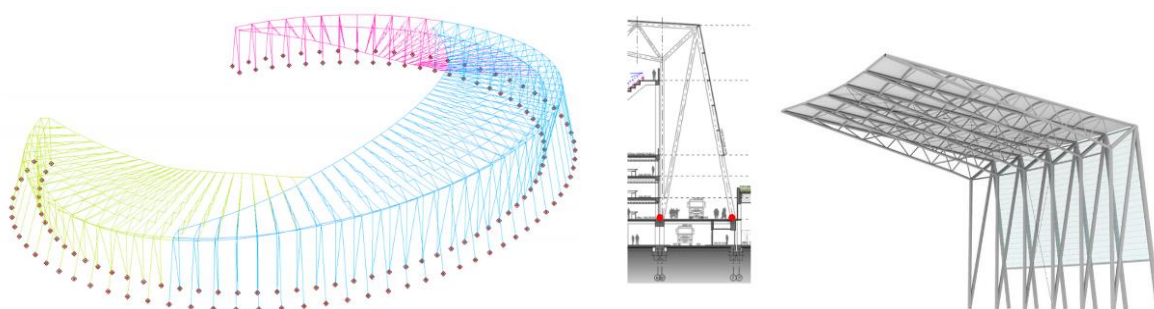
Repérage des appuis de la structure de la toiture et vue 3D d'un tronçon
